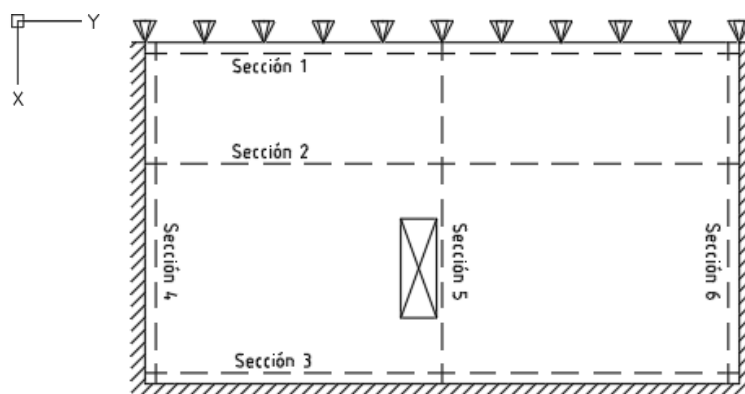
Secciones críticas de la losa maciza entre A-B/4-5.
